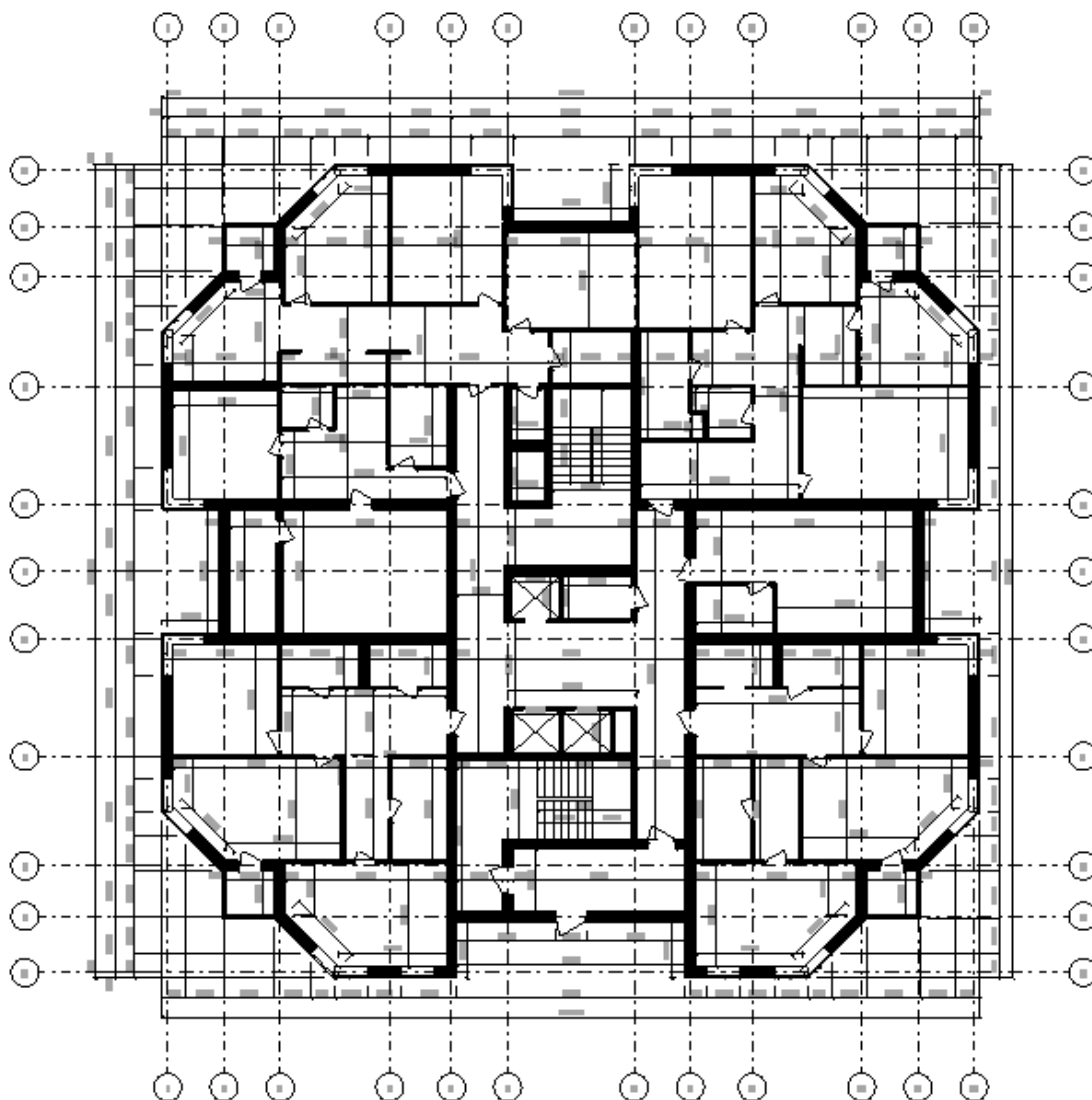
План 1 – го поверху будівлі 1 – го типу
